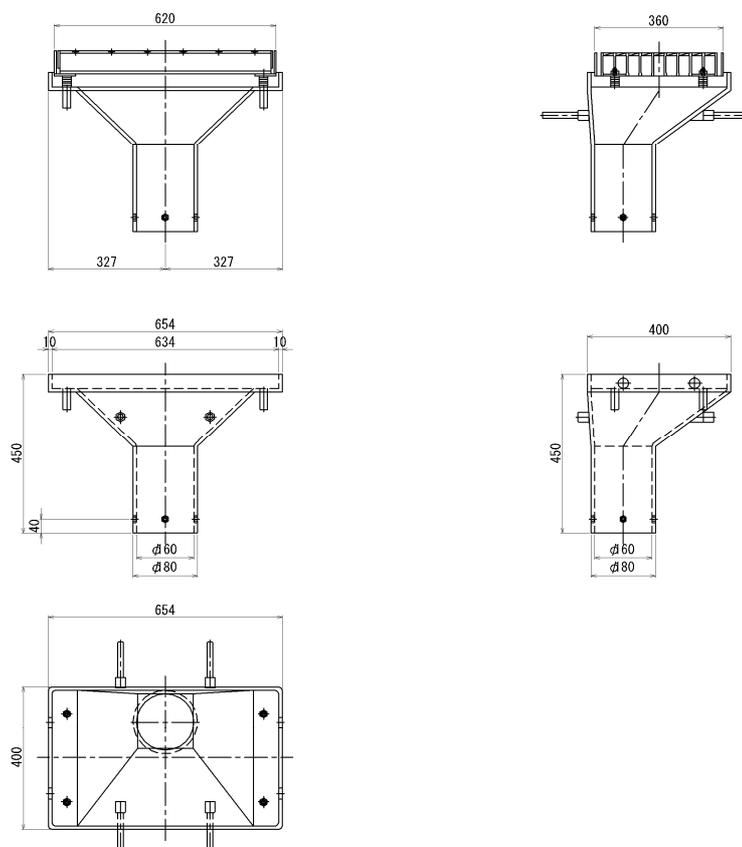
二重構造排水ます(本体 FRP 製)形状例
